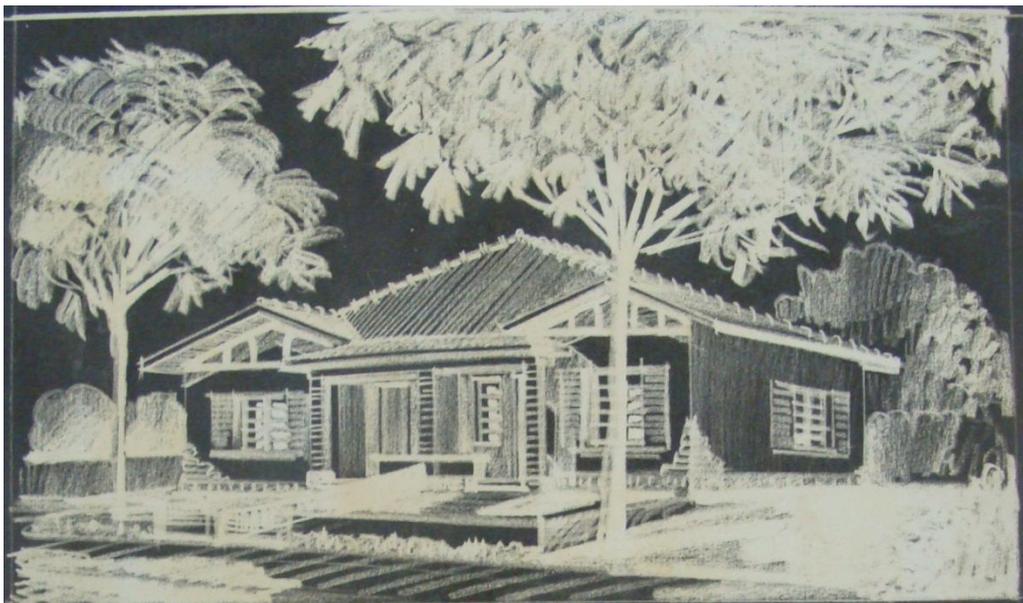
Fachada de casa-tipo da Vila Popular Mauá, 1944
